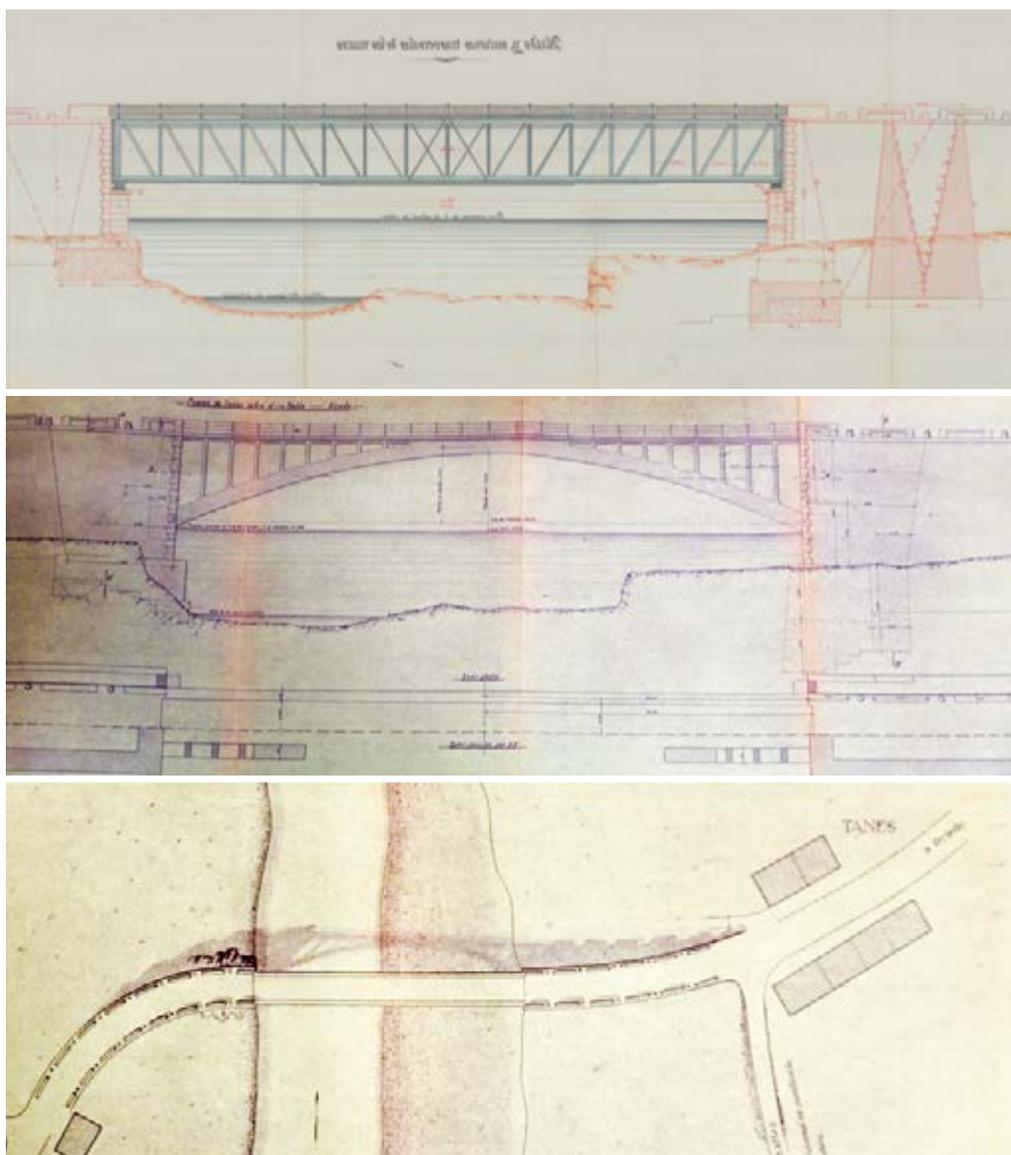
Alzado de puente metálico de Tanes³² (AGA 24-04488); en la imagen inferior, ubicación y alzado del puente de hormigón de los años 1940 que sustituyó al anterior. Hoy día este puente está sumergido en el embalse de Tanes (ADCA A5927). Escalando las imágenes, la comparación de los alzados con un deslizador puede constituir una alternativa atractiva para el observador.
